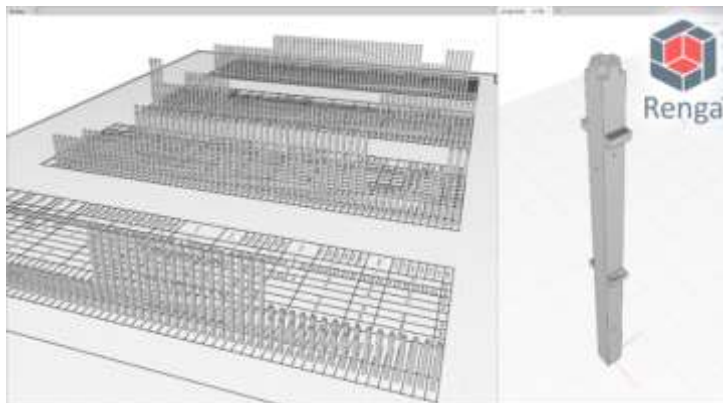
Каталог сборных железобетонных конструкций по серии 1.020 по колоннам (более 1000 элементов)
